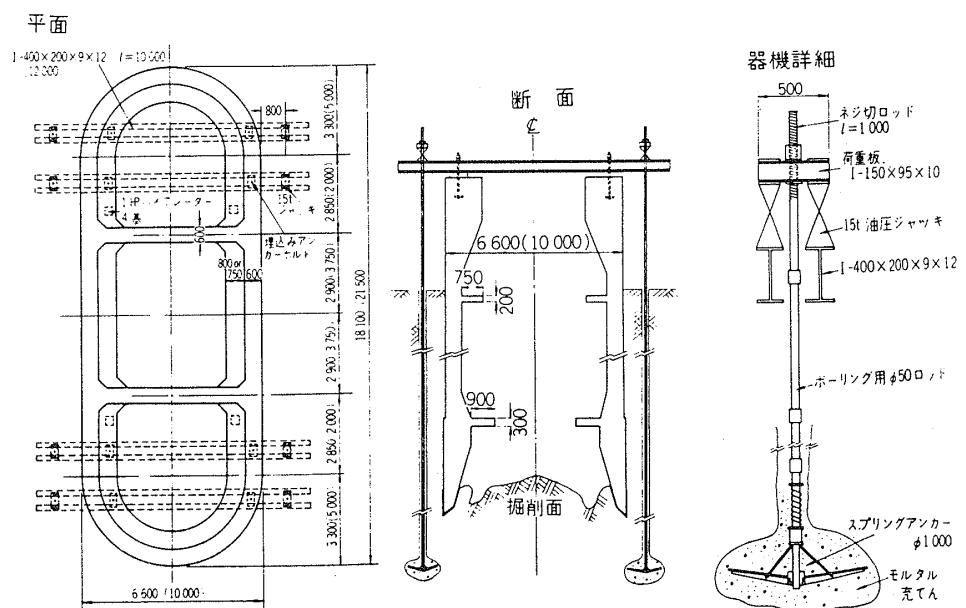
MS アンカーワーク法沈下施工図¹⁹¹⁾
